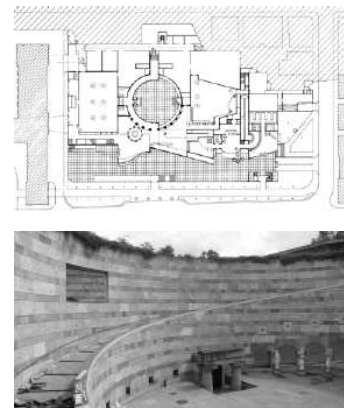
Staatsgalerie. Planta general y vista del patio cilíndrico 1977-83. James Stirling & Leon Krier.
